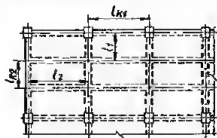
Обозначения расчетных пролетов плит монолитных ребристых перекрытий.
